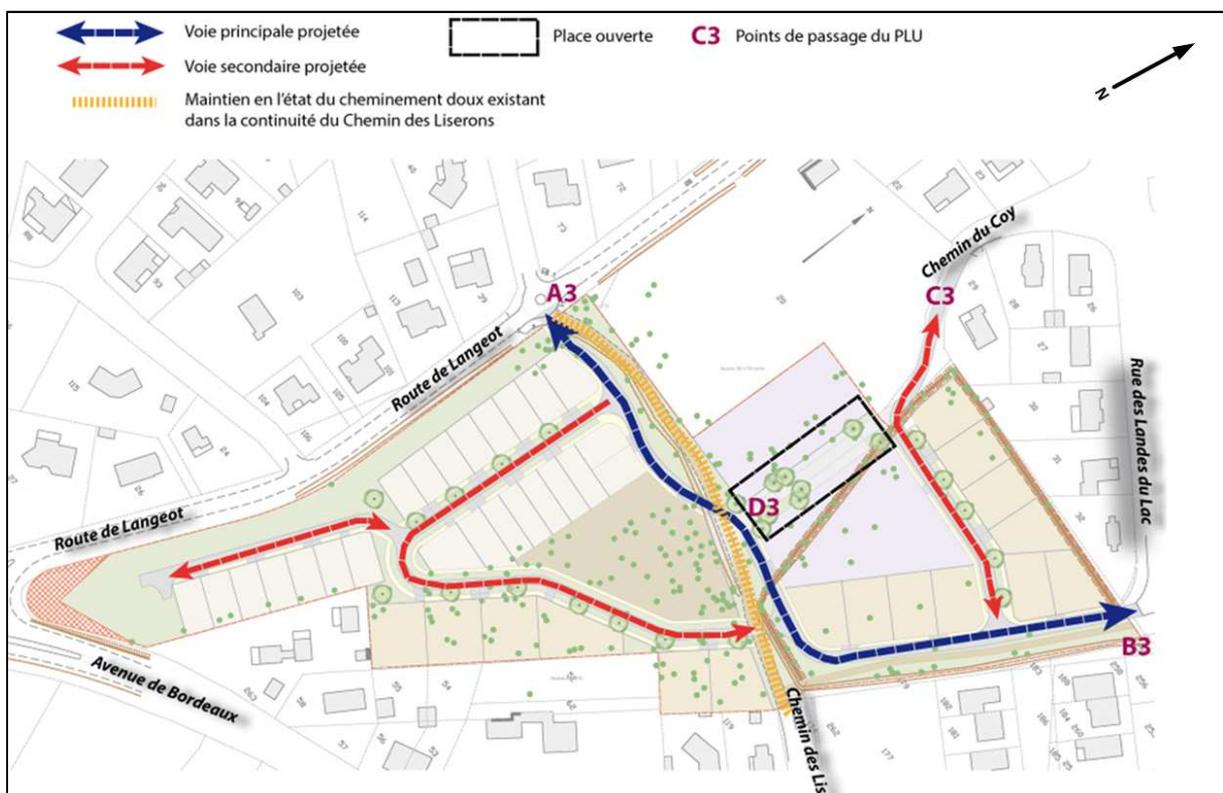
Esquisse du projet (Source : plan de composition - AUIGE)
